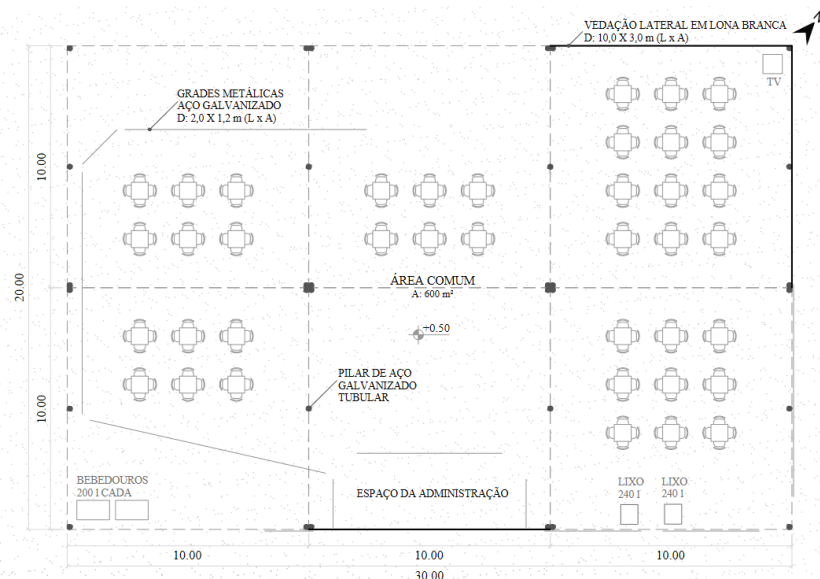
Planta baixa da área multiuso. Fonte: Carbonari (2021).
